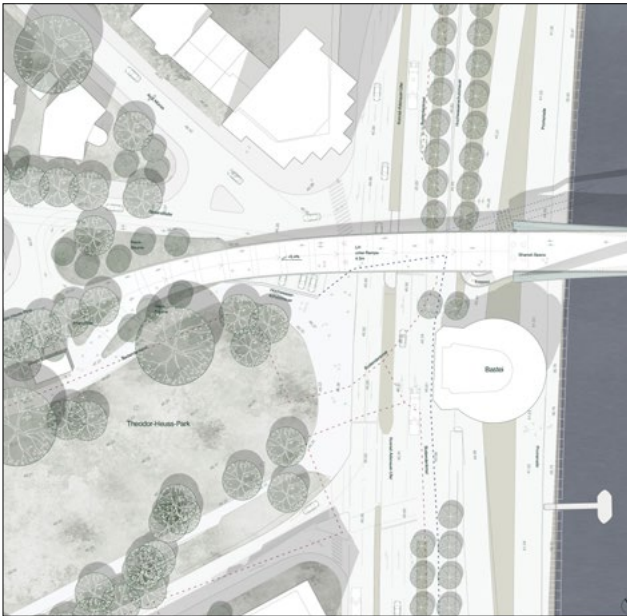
Grundriss linksrheinische Rampe
